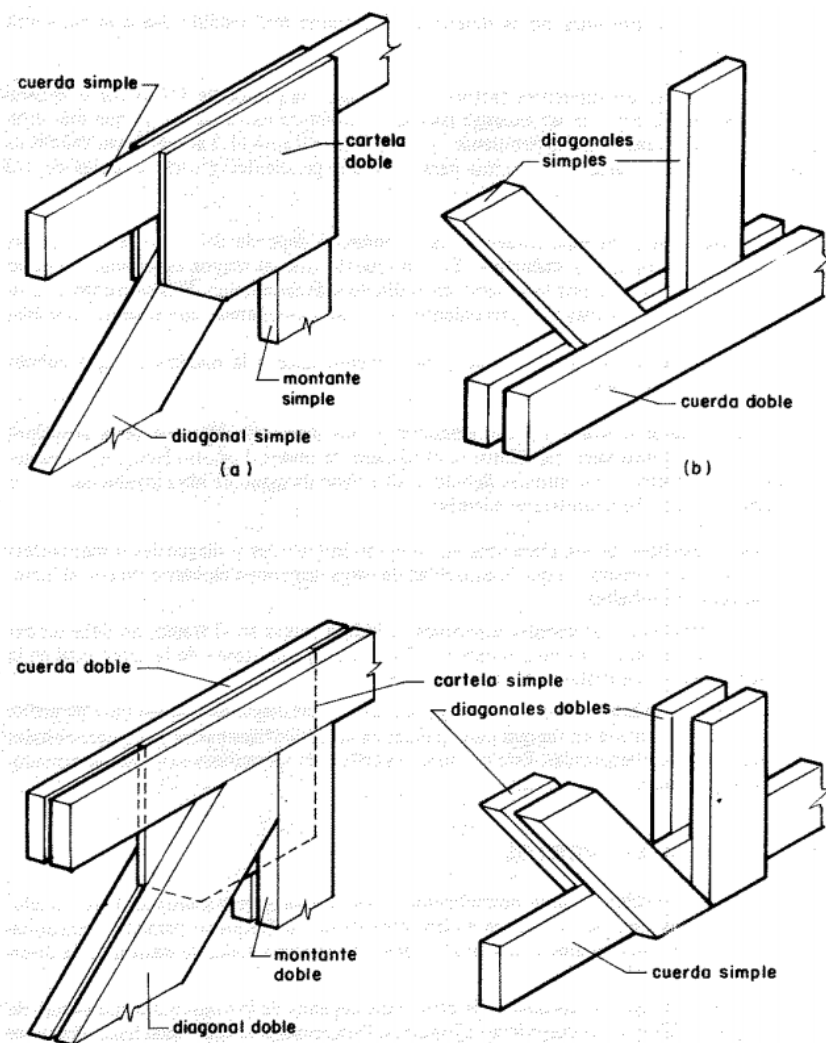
Elementos de empalme en las armaduras de madera. JUNAC, 1984
